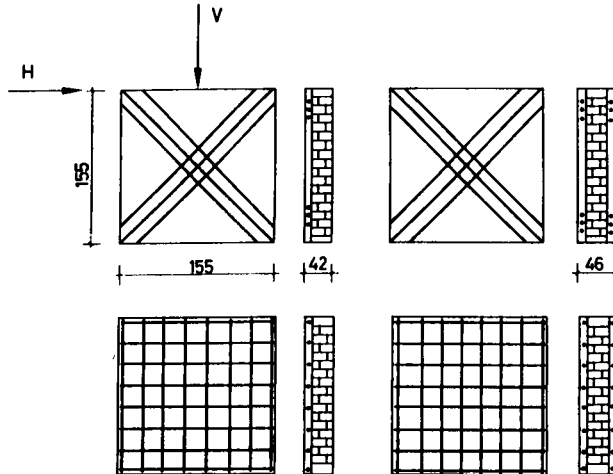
Verstärkung von Mauerwerkskörpern mit betonstahlbewehrten Ergänzungsschichten aus Spritzbeton [13]
